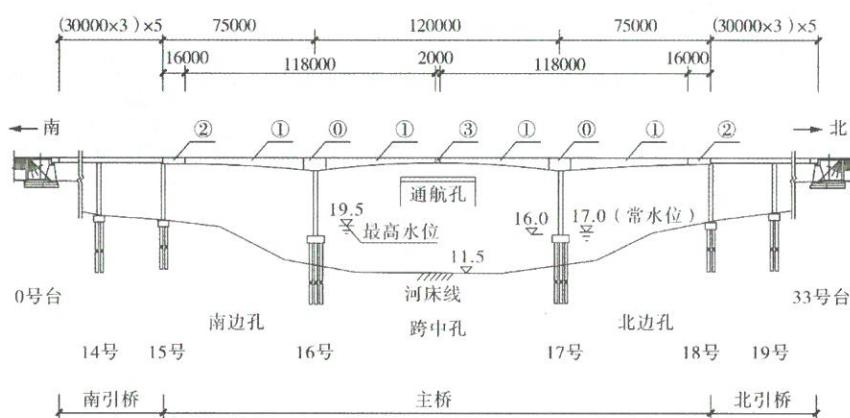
桥梁立面布置及主桥上部结构施工区段划分示意图
